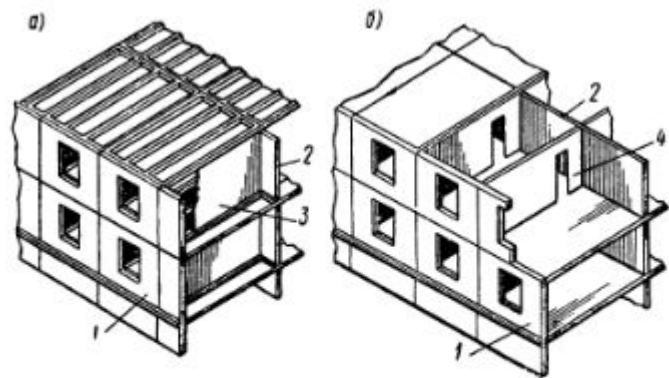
Конструктивные схемы бескаркасных панельных зданий
